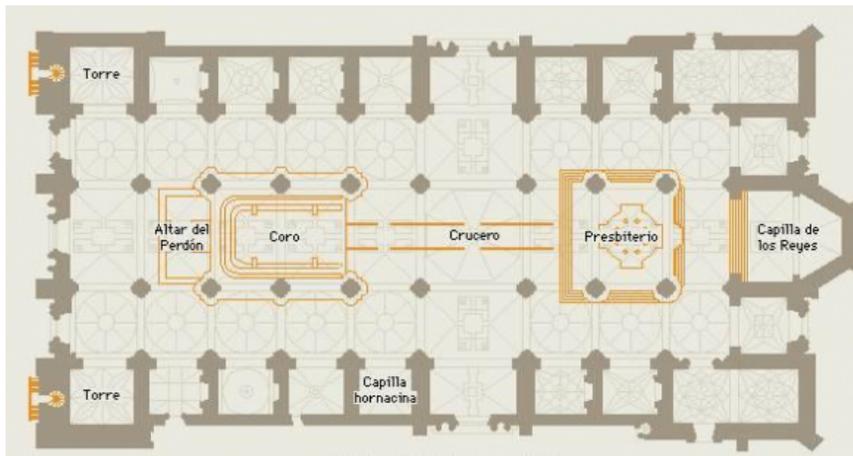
Planta arquitectónica de la Catedral Metropolitana
